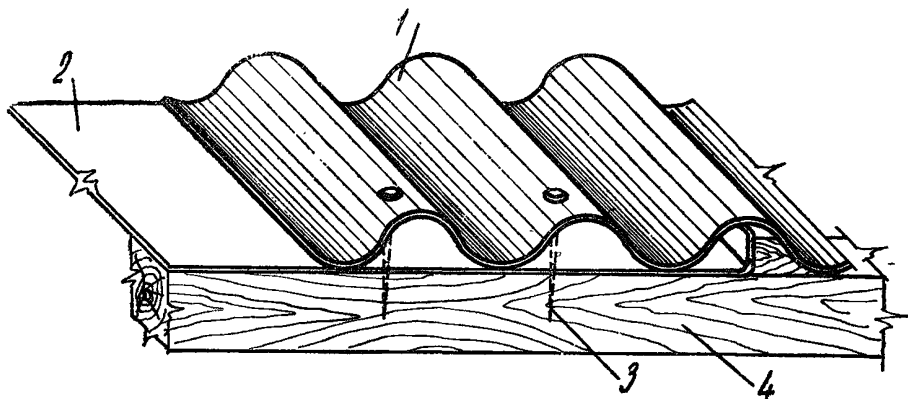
Деталь примыкания кровли из стеклопластика к стальной кровле. 1 — волнистый лист стеклопластика; 2 — лист кровельной стали; 3 — гвозди; 4 — брусok обрешетки.
